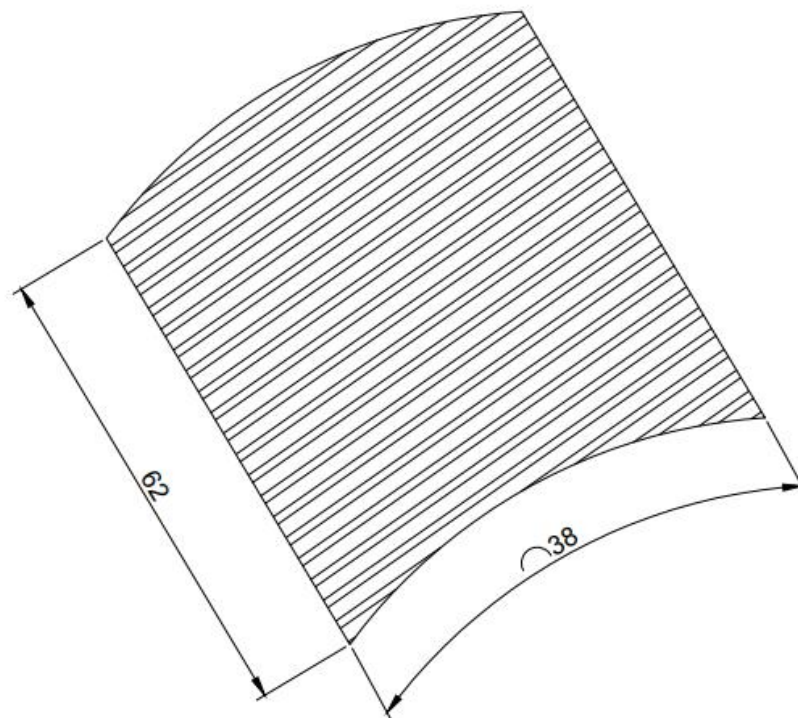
Esquemática da área de captação do telhado (Dimensões em metros) (Autor)
